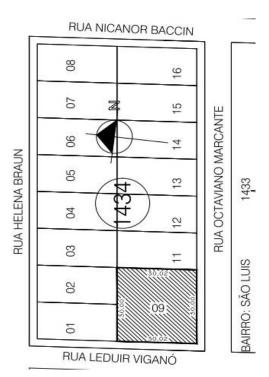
Planta de situação Fonte: Projeto Arquitetônico (2017).
